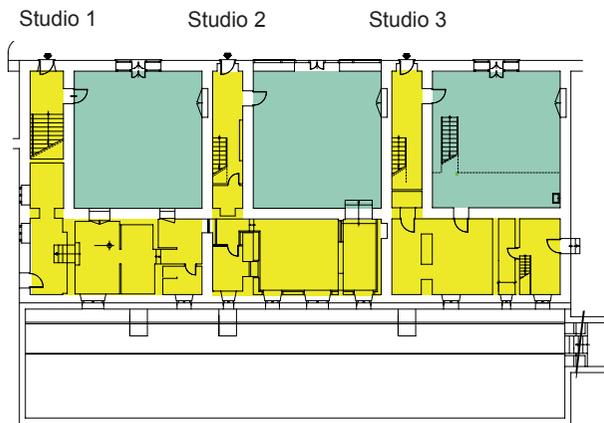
Abb. 2.2.2.9 Grundrisse EG + OG | Studios mit Atelierraum
